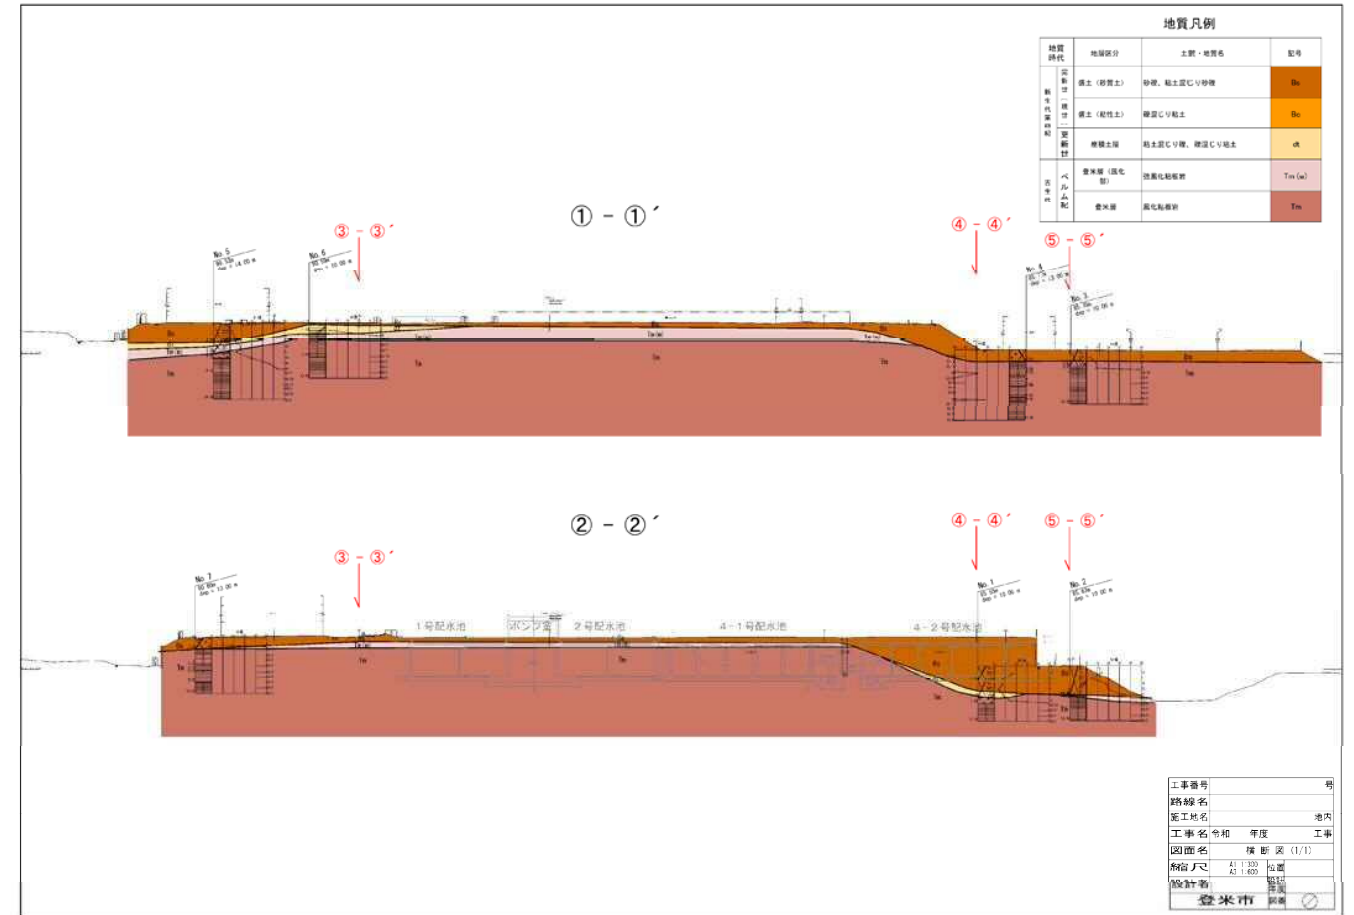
地質断面図 (①-①'、②-②' 断面)
